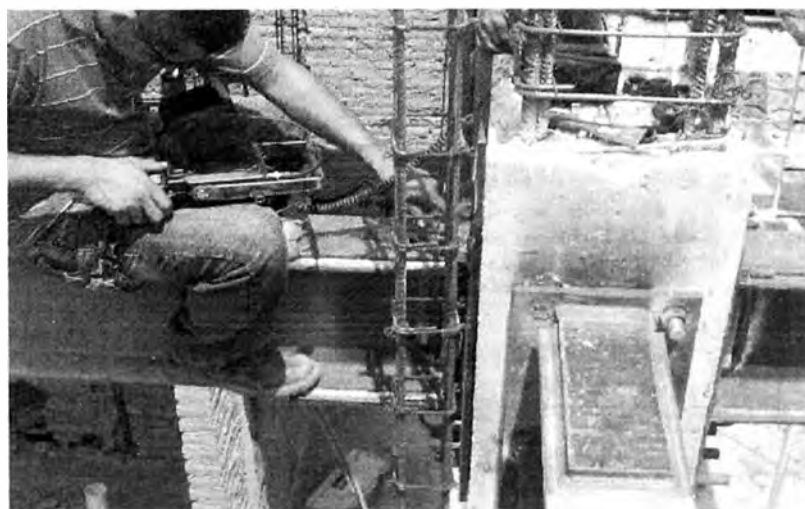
Inspección de la soldadura por ultrasonido.
